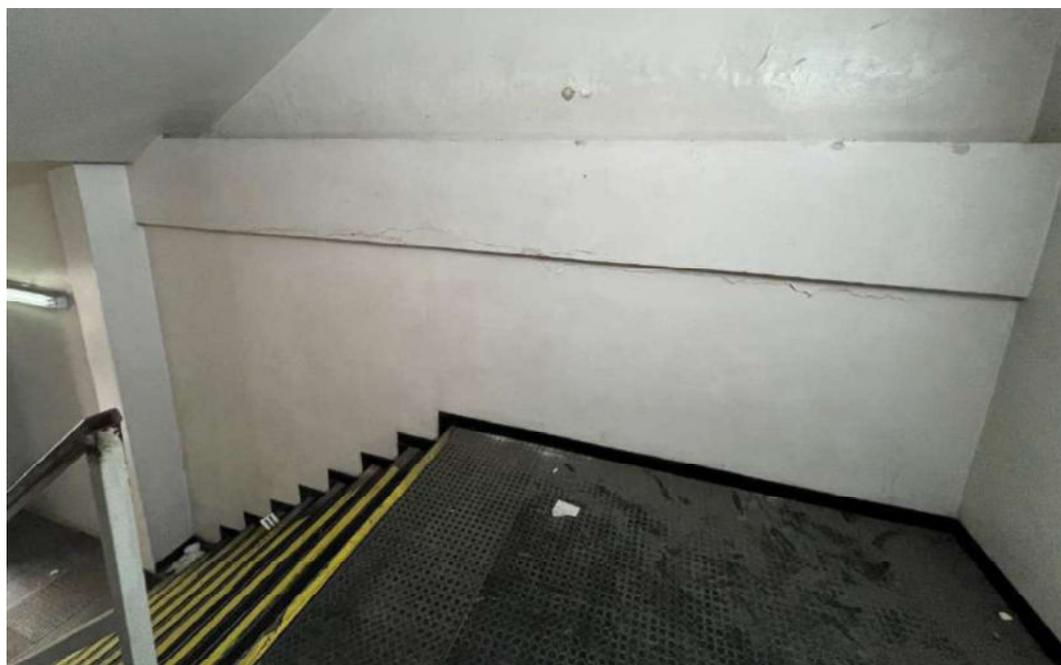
Visão geral - Deslocamento do concreto de cobertura na viga 244 e abaixo dela
